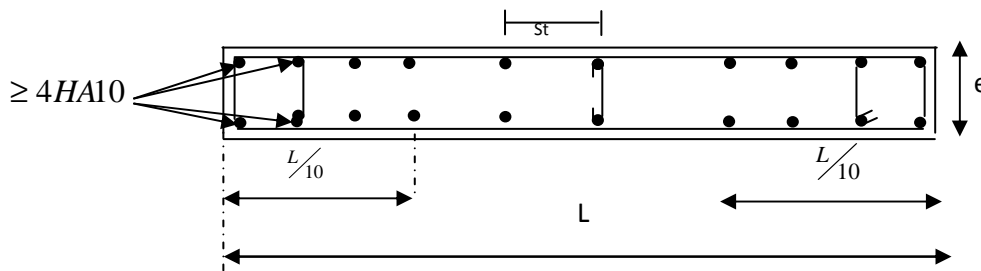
Disposition des armatures verticales dans les voiles.
